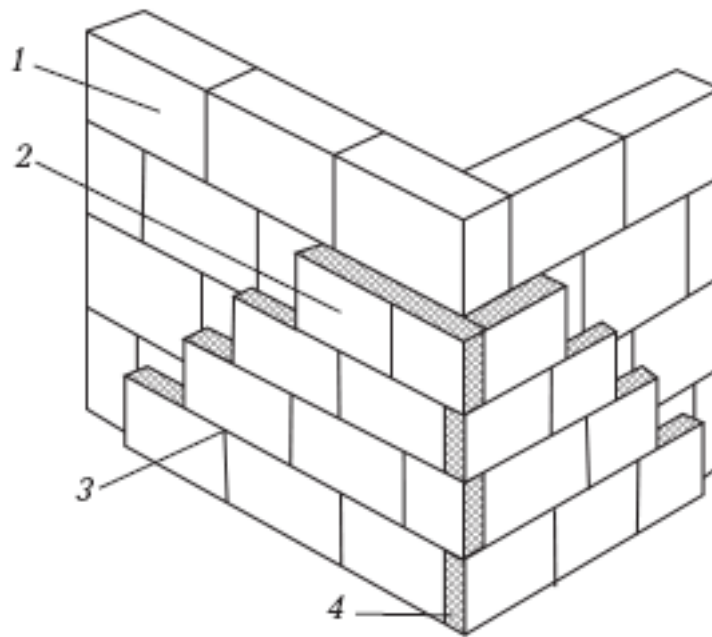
Схема укладки утеплителя: 1 – несущая стена; 2 – теплоизоляционные плиты; 3 – Т-образные стыки плит при укладке вразбежку; 4 – зубчатое зацепление плит в углах здания
